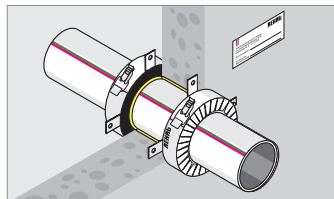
Монтаж противопожарной манжеты на стене.
